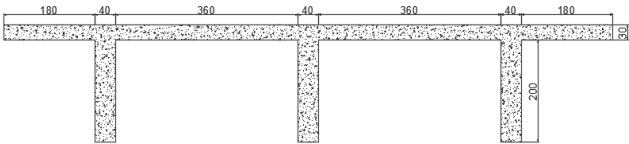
Seção transversal da ponte adotada (dimensões em cm)
